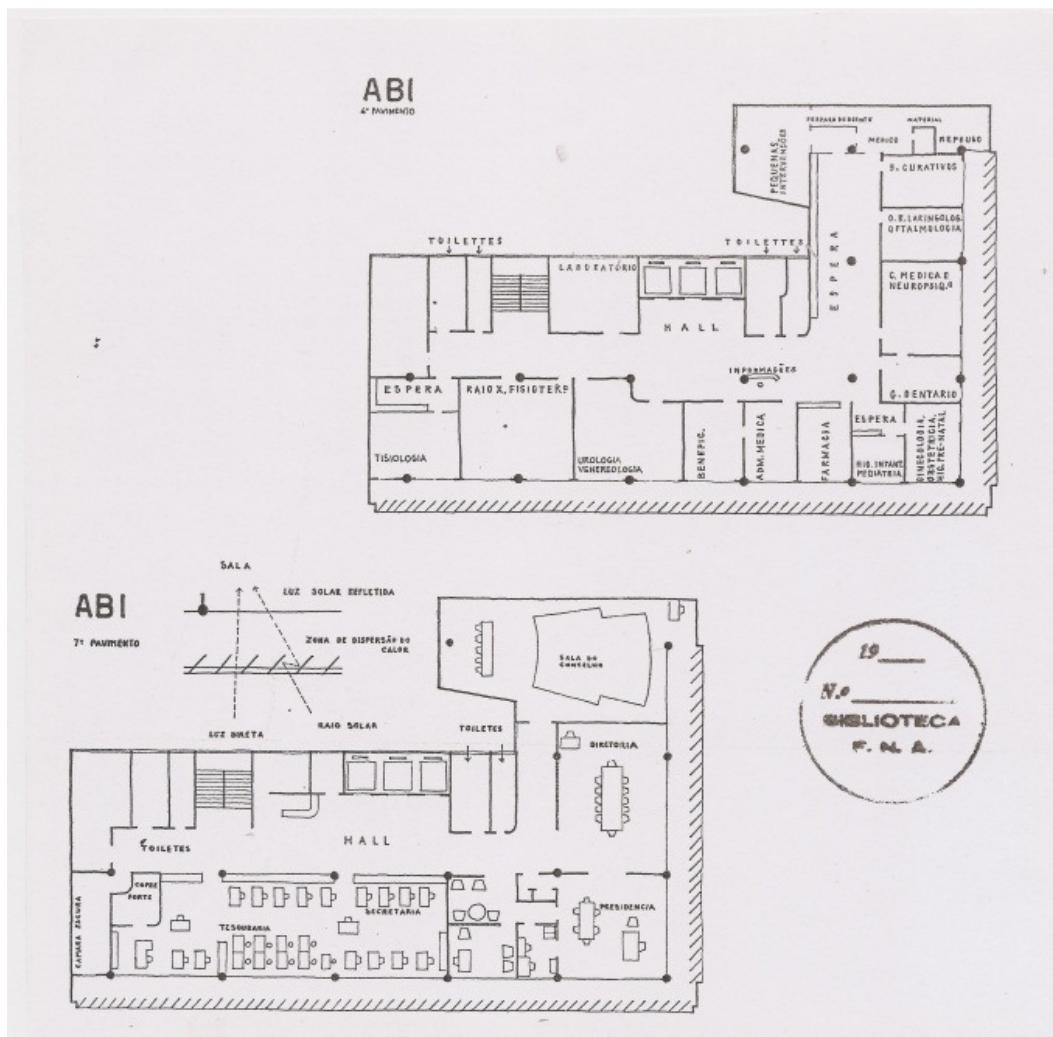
G – Plantas baixas do sexto pavimento (setor médico) e sétimo pavimento
